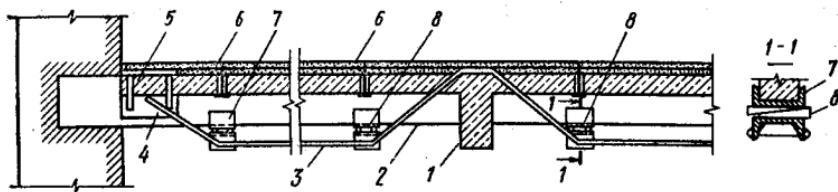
Усиление железобетонного монолитного перекрытия:
